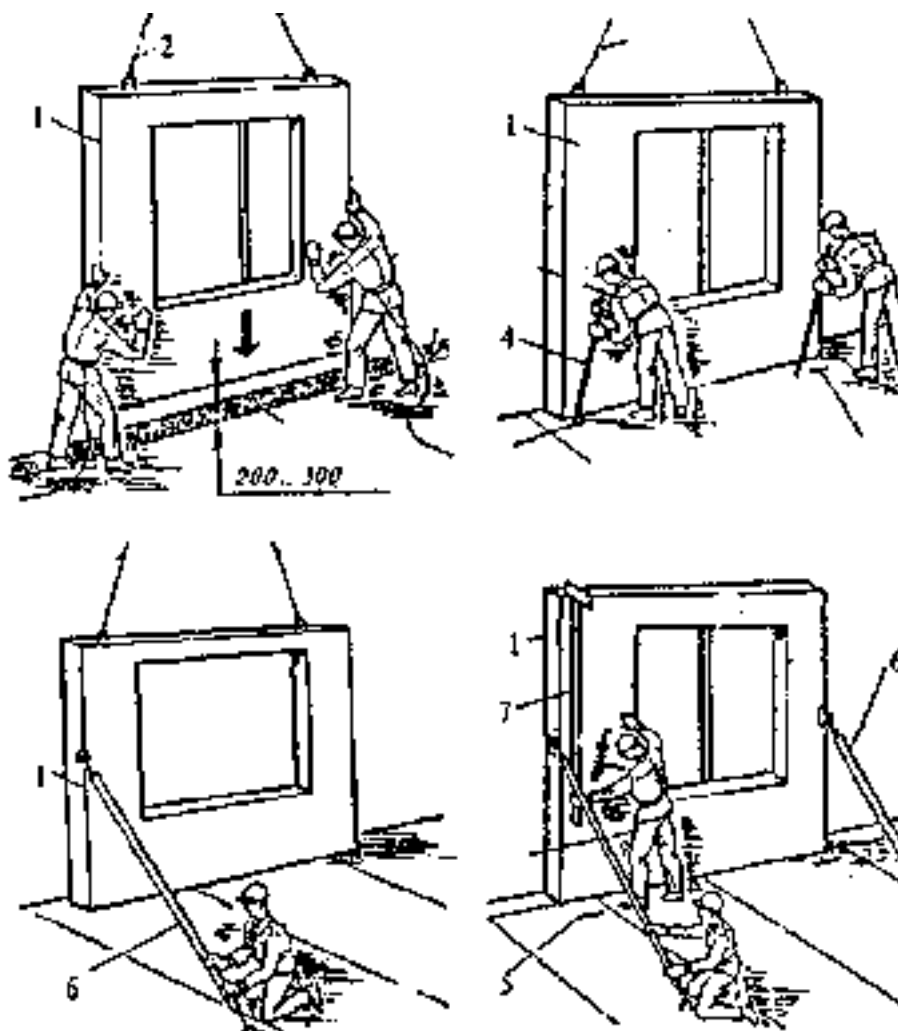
Схема последовательного монтажа наружной стеновой панели:
